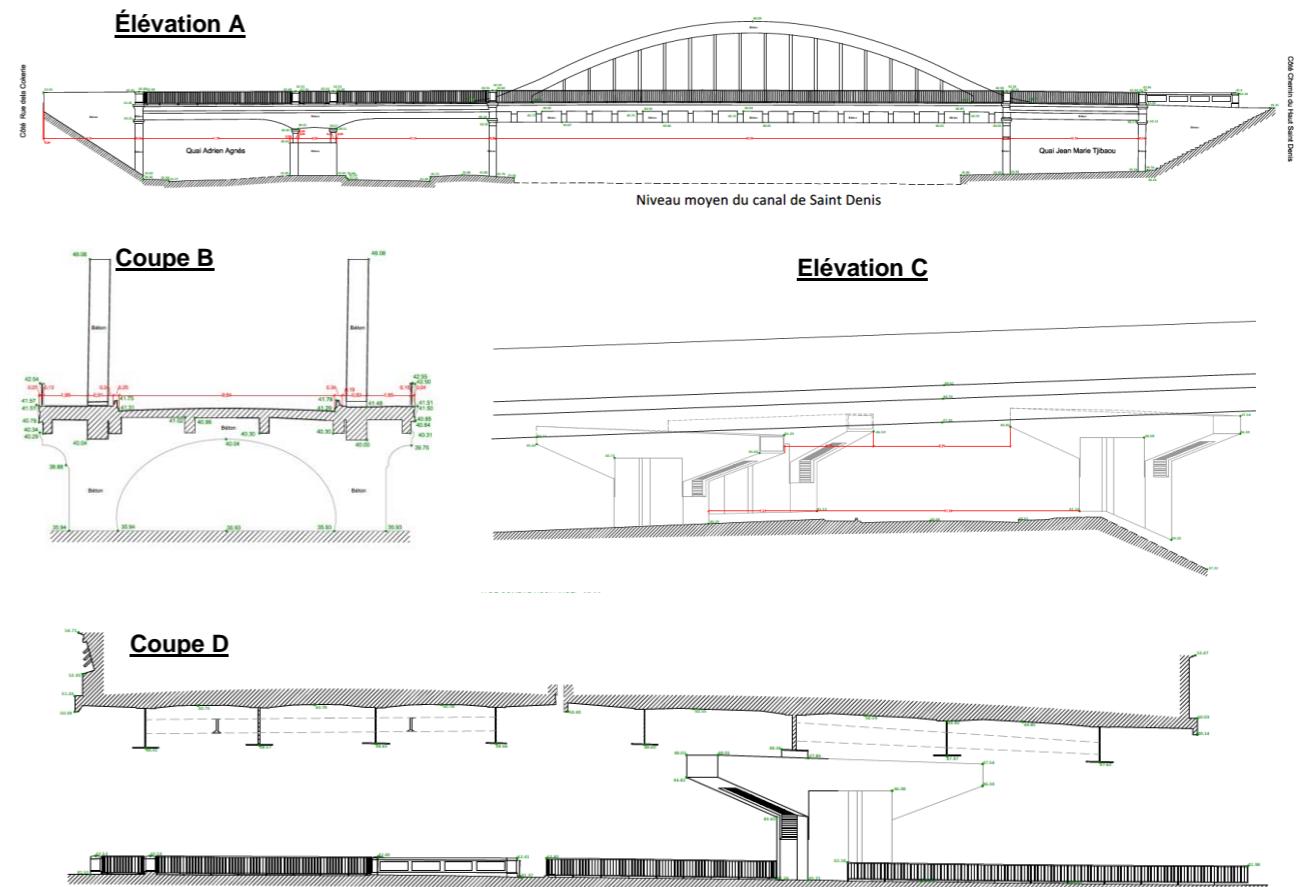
Pont Pressensé - Élévations et Coupes transversales
